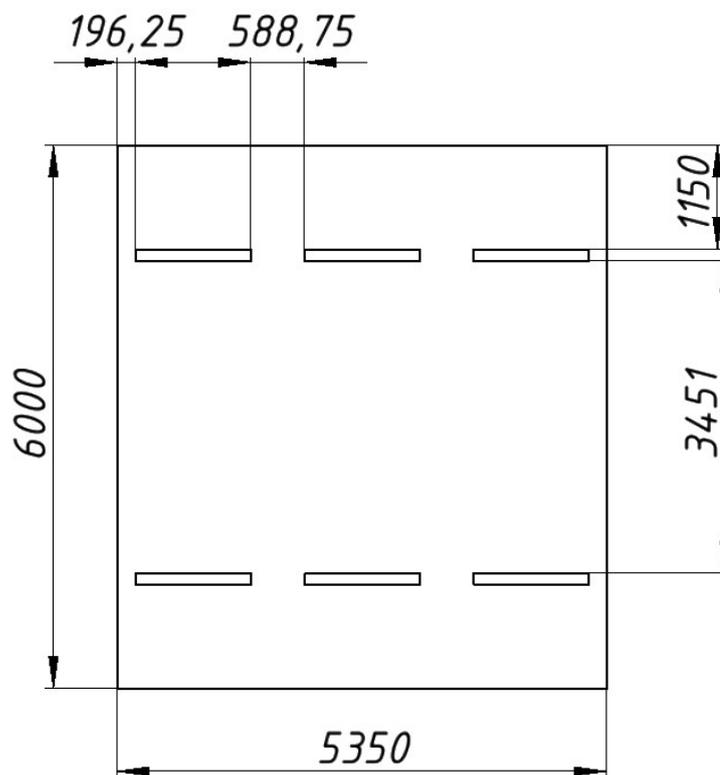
План помещения и размещения светильников со светодиодными лентами
